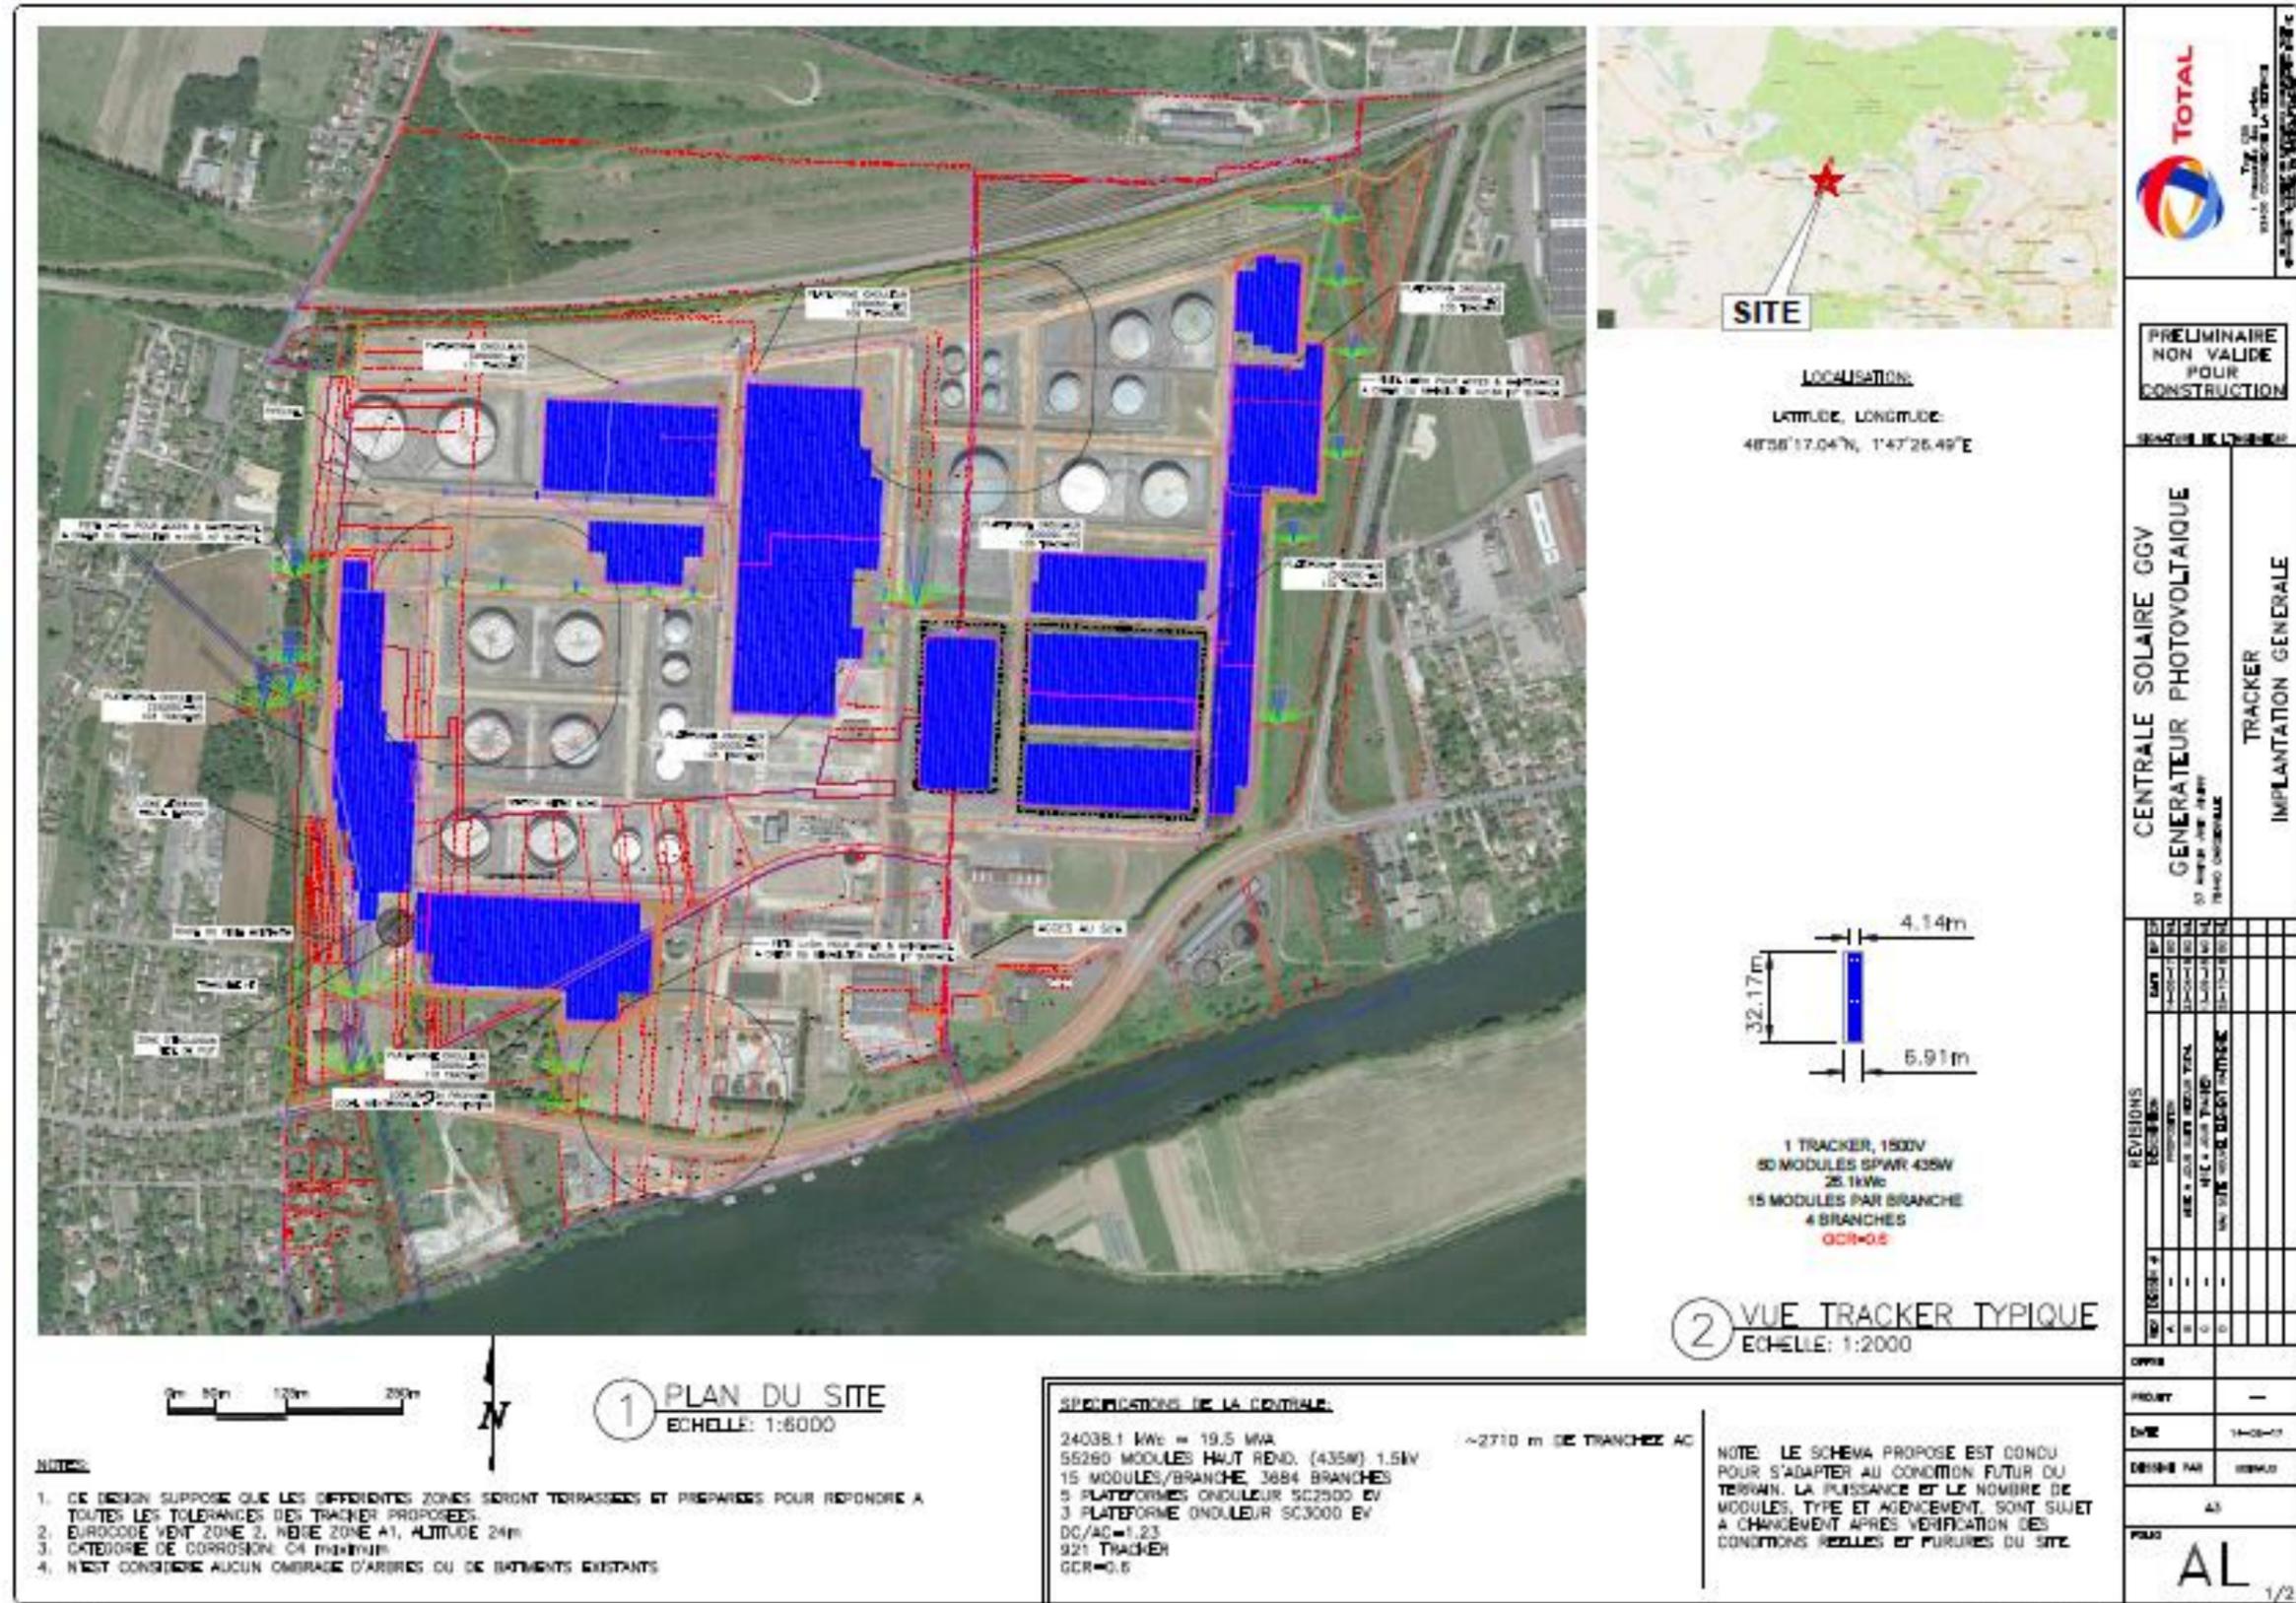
Plan d'implantation de la centrale solaire photovoltaïque au sol de Gargenville Source : Total Solar – Permis de construire
